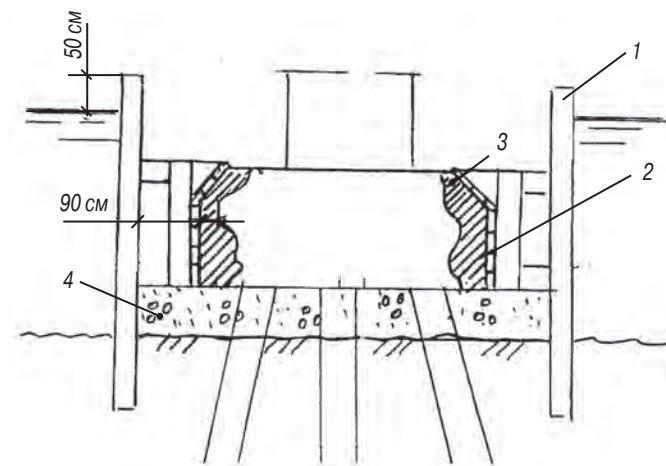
Устройство железобетонной рубашки для подводной части опоры: 1 – ограждение; 2 – опалубка; 3 – рубашка; 4 – тампонажный слой бетона
